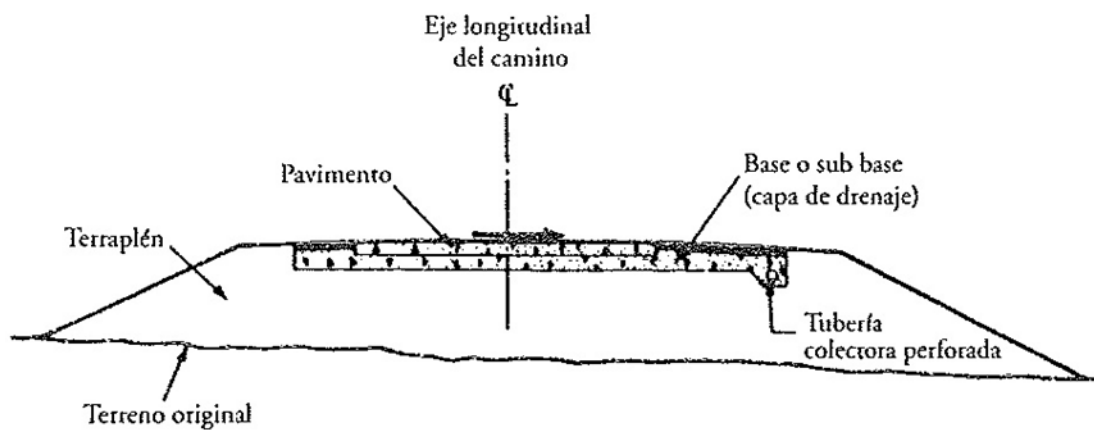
Dren colector longitudinal que se usa para retirar el agua que se percola hacia la sección estructural del pavimento (Garber & Hoel, 2007).
